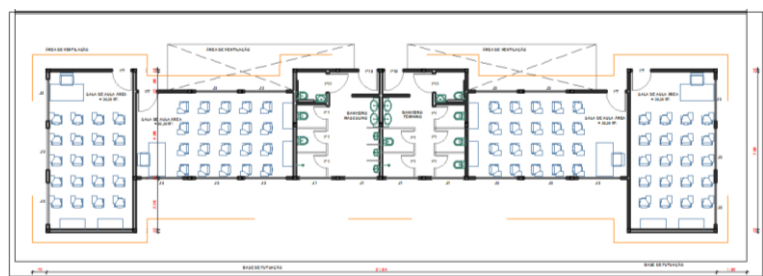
Planta baixa do bloco flutuante 3 de salas de aula e banheiros.
